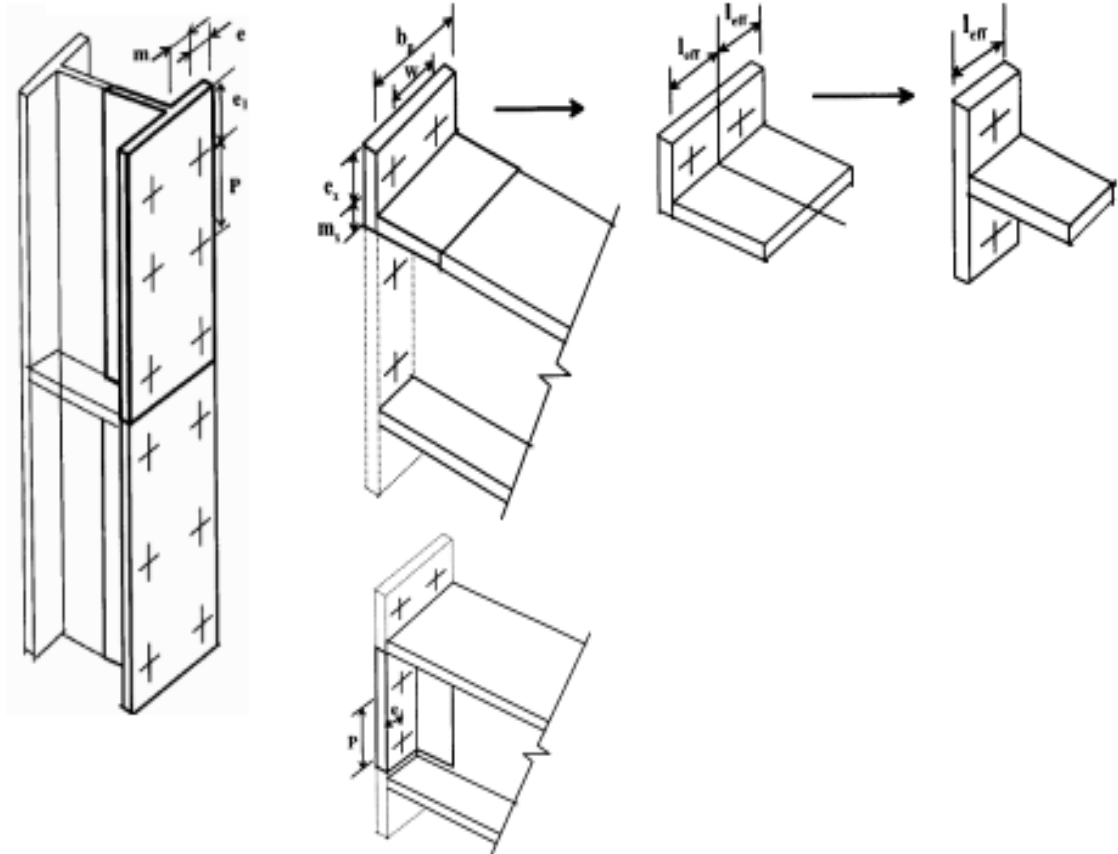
Modélisation de l'assemblage avec platine d'about par des tronçons en té - a) semelle du poteau raidi - b) platine d'about débordante
